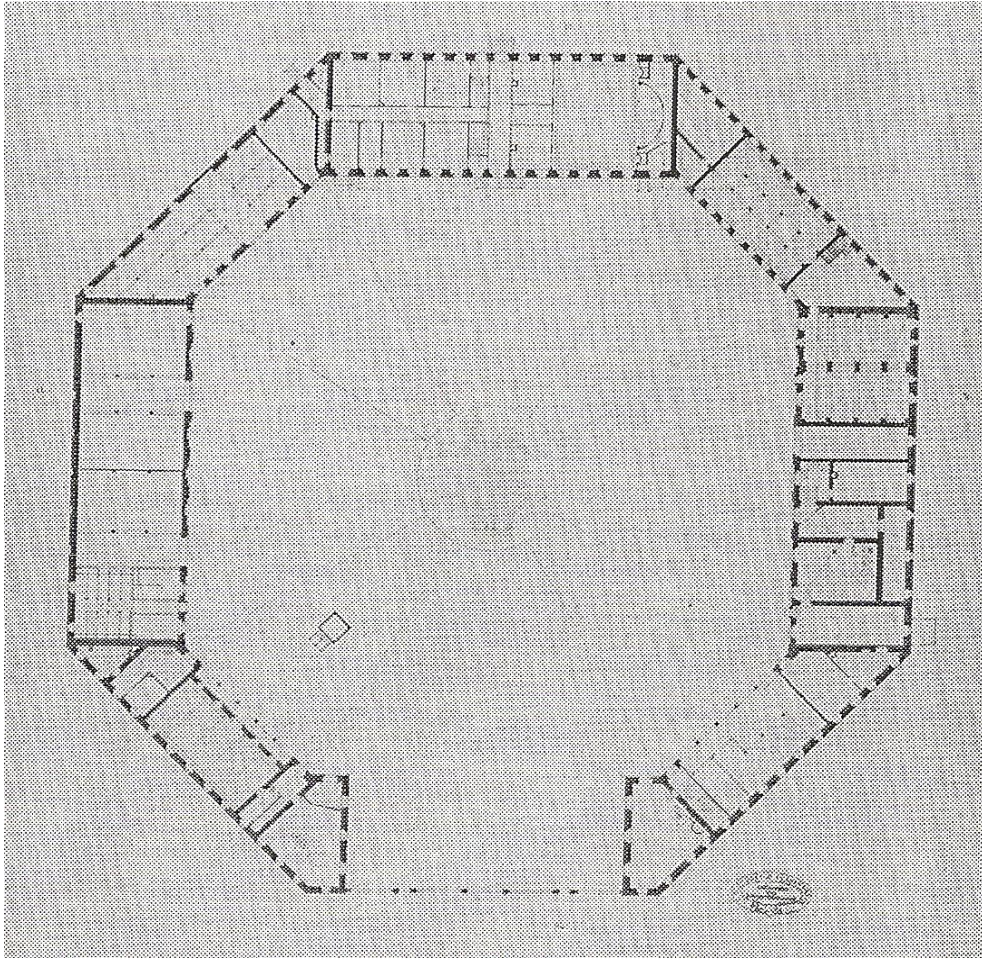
Bethmannscher Riedhof, Grundriss Erdgeschoss. Bauaufnahme um 1896
